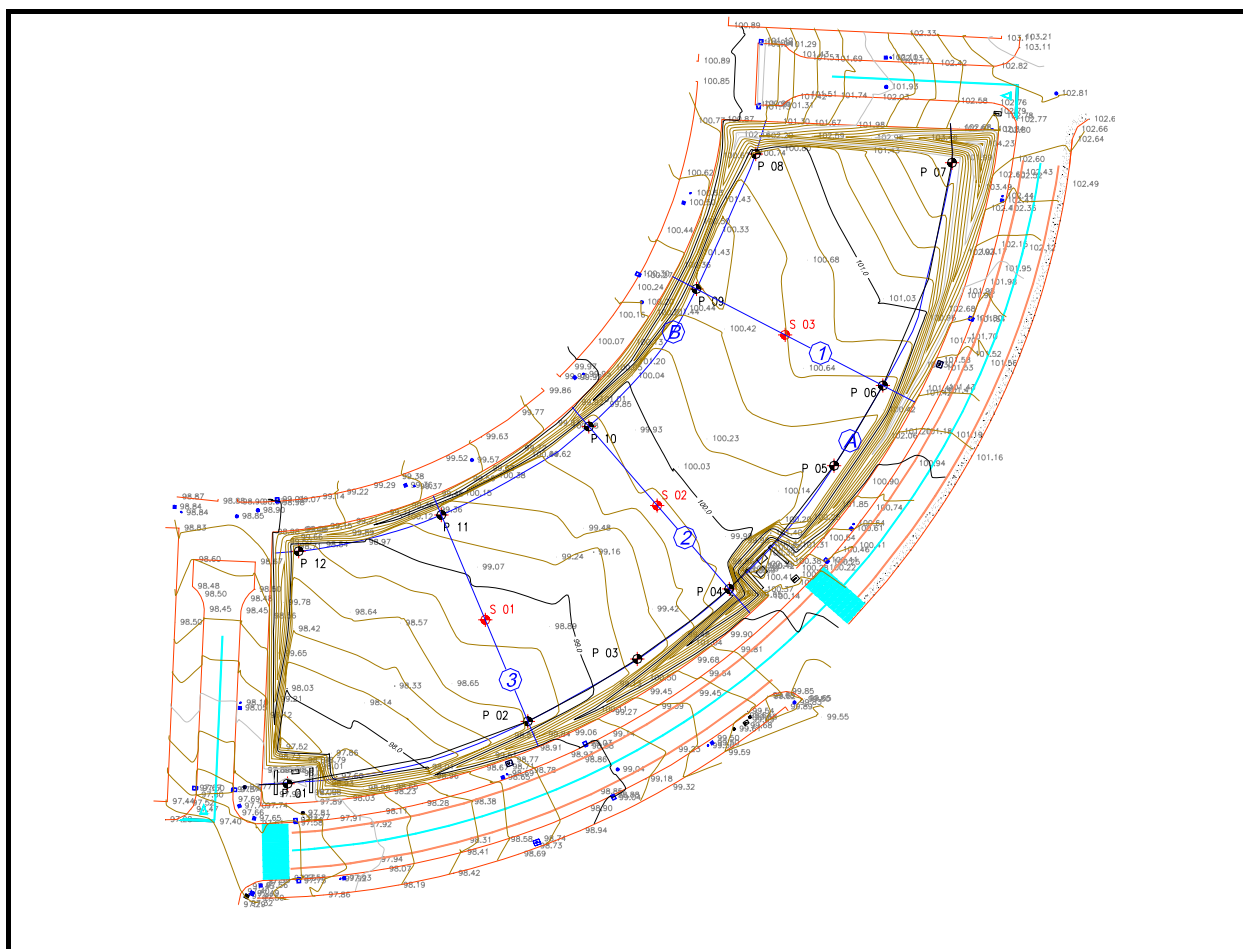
Planta topográfica y de situación de los reconocimientos geotécnicos.
